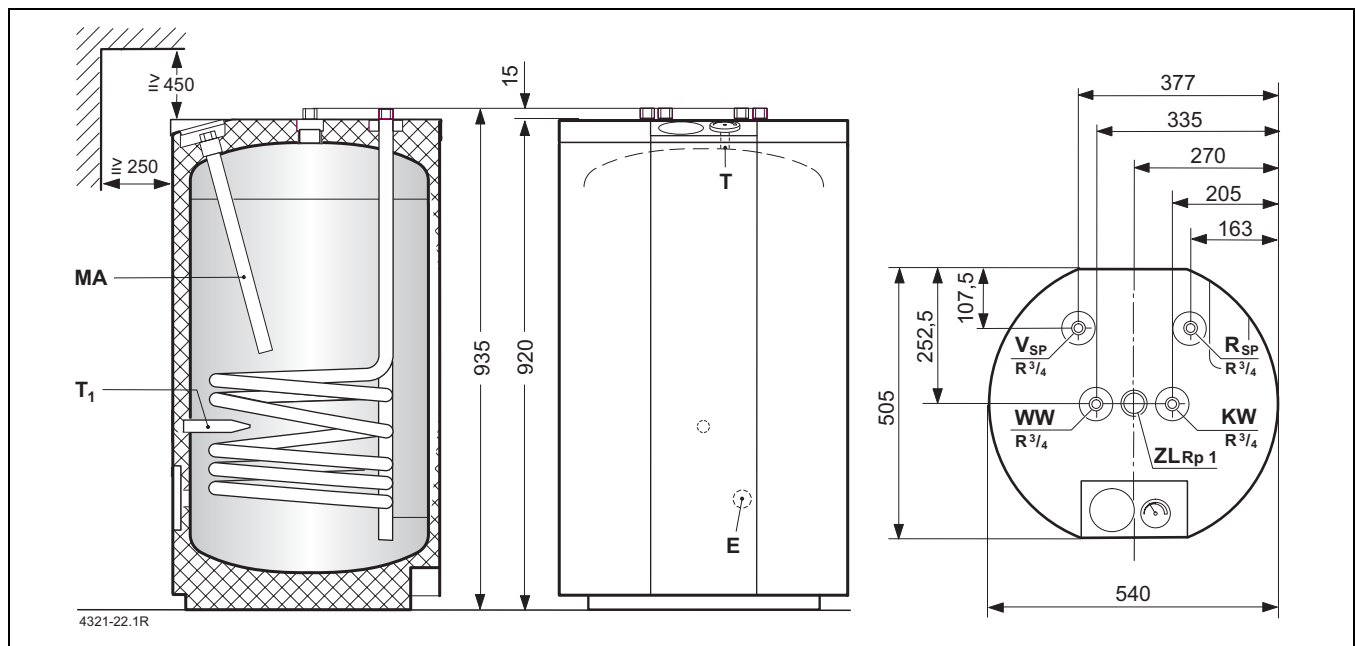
Bau- und Anschlussmaße ST 120-1 Z
